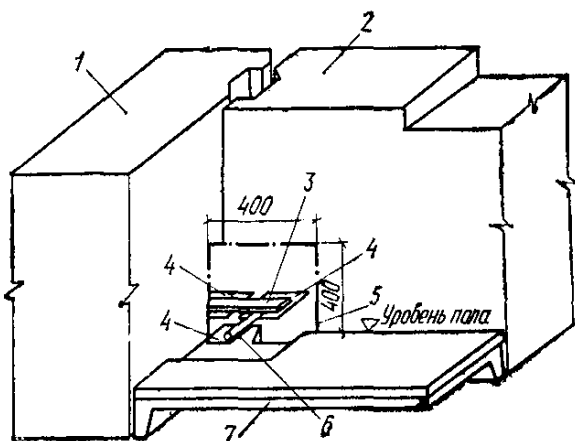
Узел соединения наружных панелей с панелями перекрытия в рядовом стыке домов серии 1ЛГ-507
